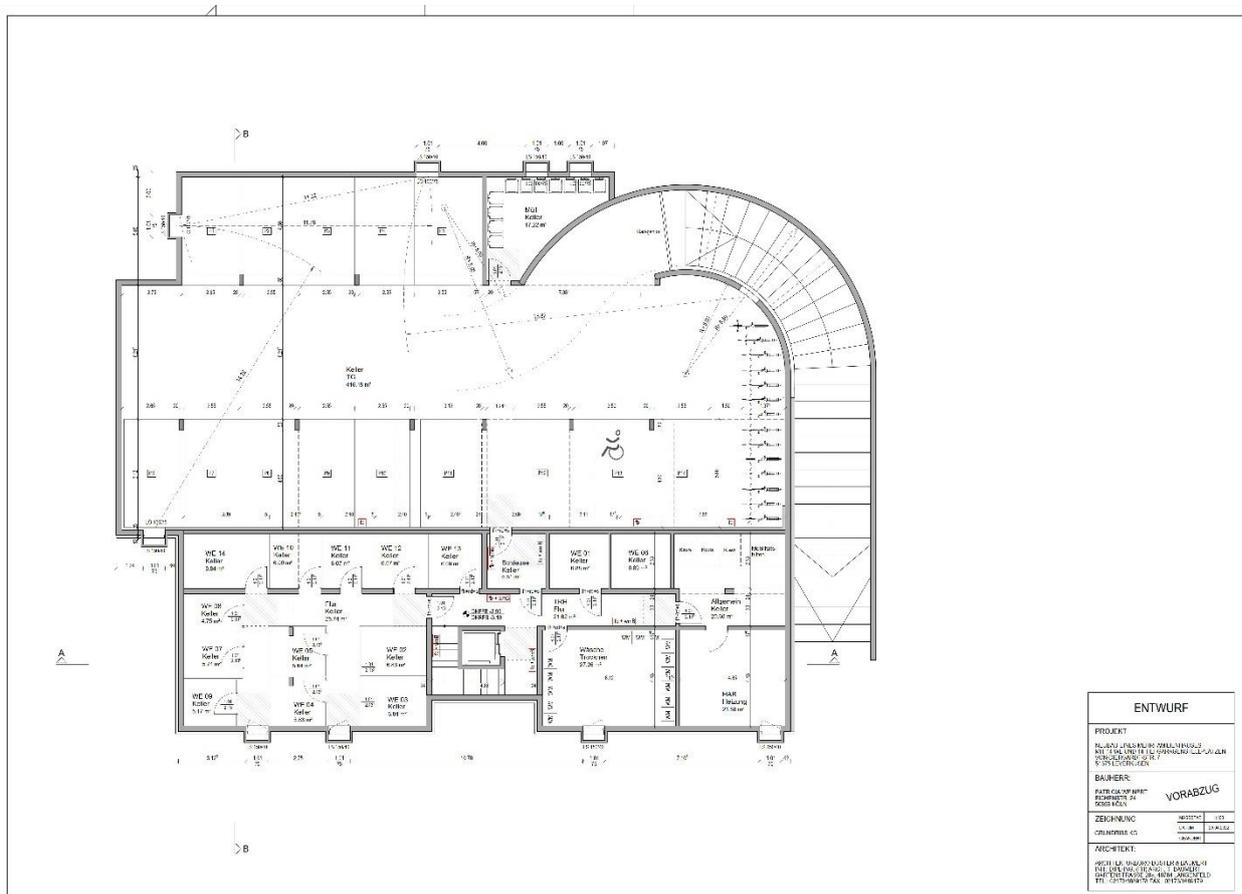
Lageplan KG Bauvorhaben mit Tiefgaragenzufahrt, ohne Maßstab, nicht genordet
